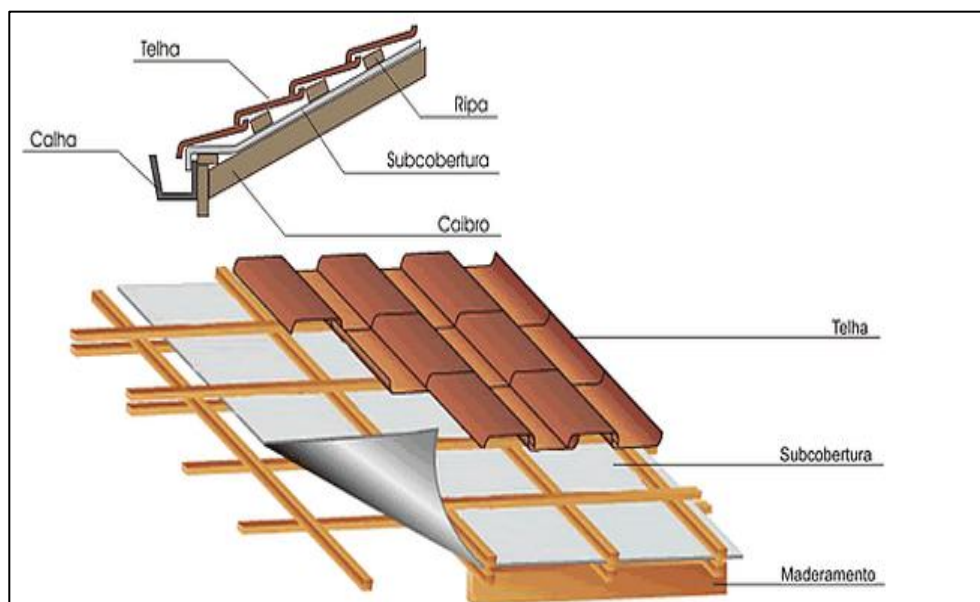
Pormenor de impermeabilização de uma cobertura de telha.
